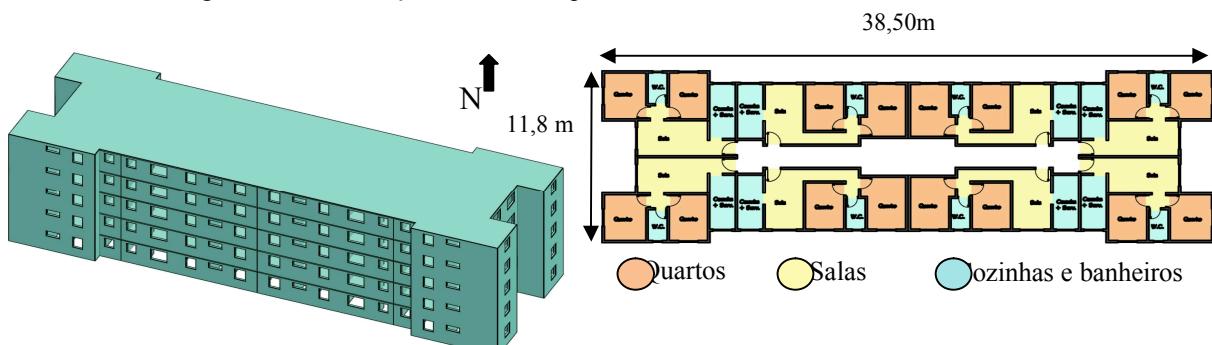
Visualização em 3d e em planta baixa do edifício do estudo de caso 3.
